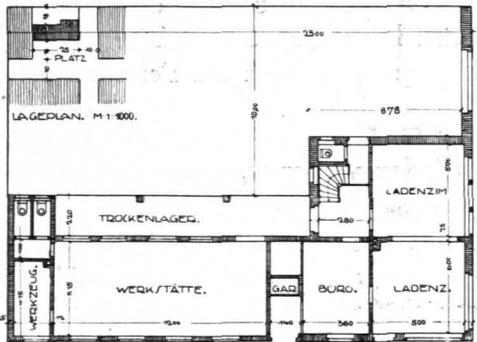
ANSICHTEN UND GRUNDRISSSE. (M. 1:400.)
